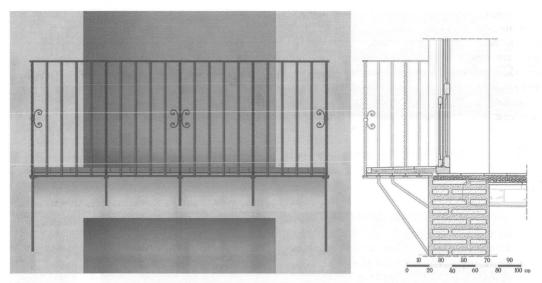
Alzado y sección constructiva de un balcón de calle Valldigna
